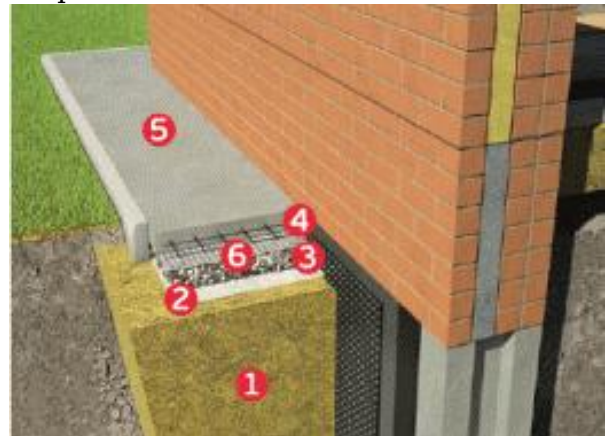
Конструкция жесткой отмостки: 1 – песок; 2 – геотекстиль; 3 – щебень; 4 - сетка для армирования; 5 – бетон; 6 – полиэтиленовая пленка
